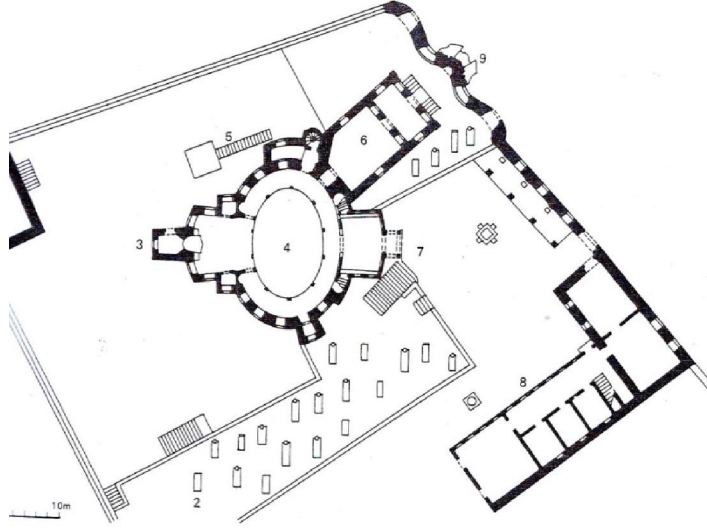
مسقط أفقى لجامع آيا صوفيا وملحقاته عن:
